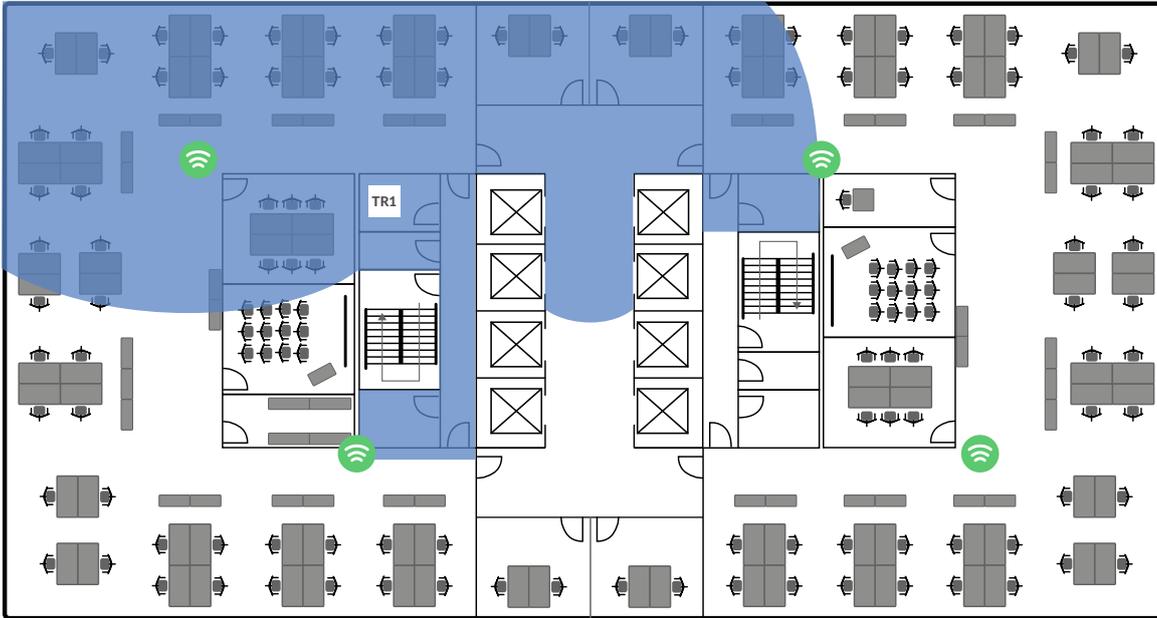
24m Zone bei einem Stockwerkverteiler TR1 (Technikraum)
